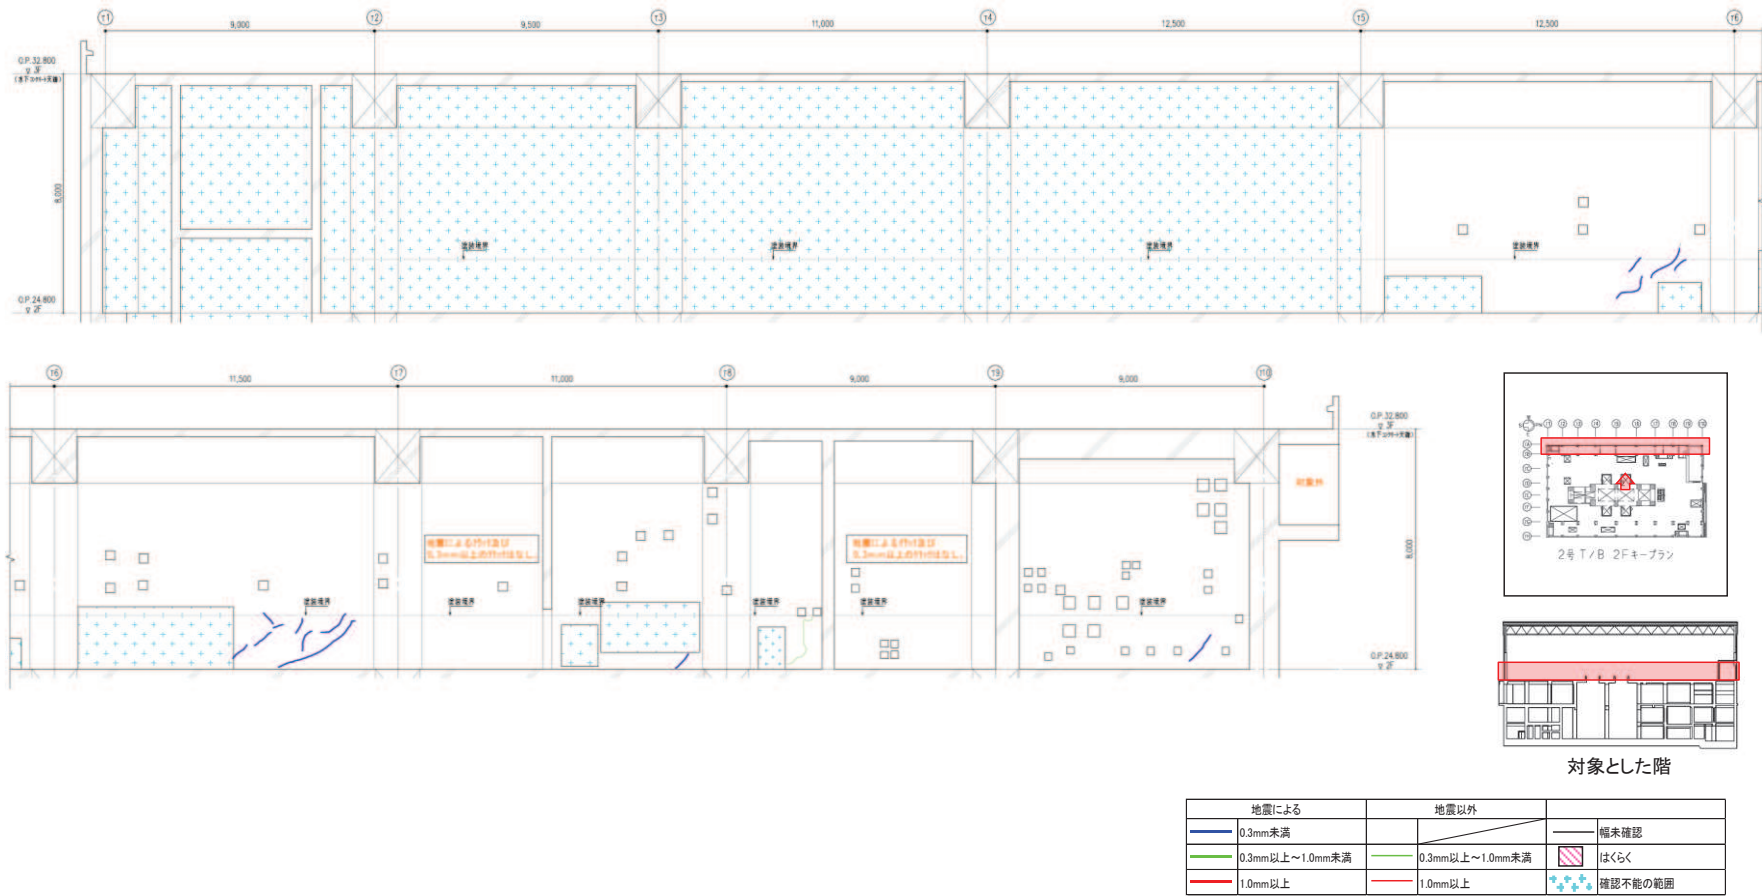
タービン建屋のひび割れ分布 耐震壁 (51) 2階 TA 通り
